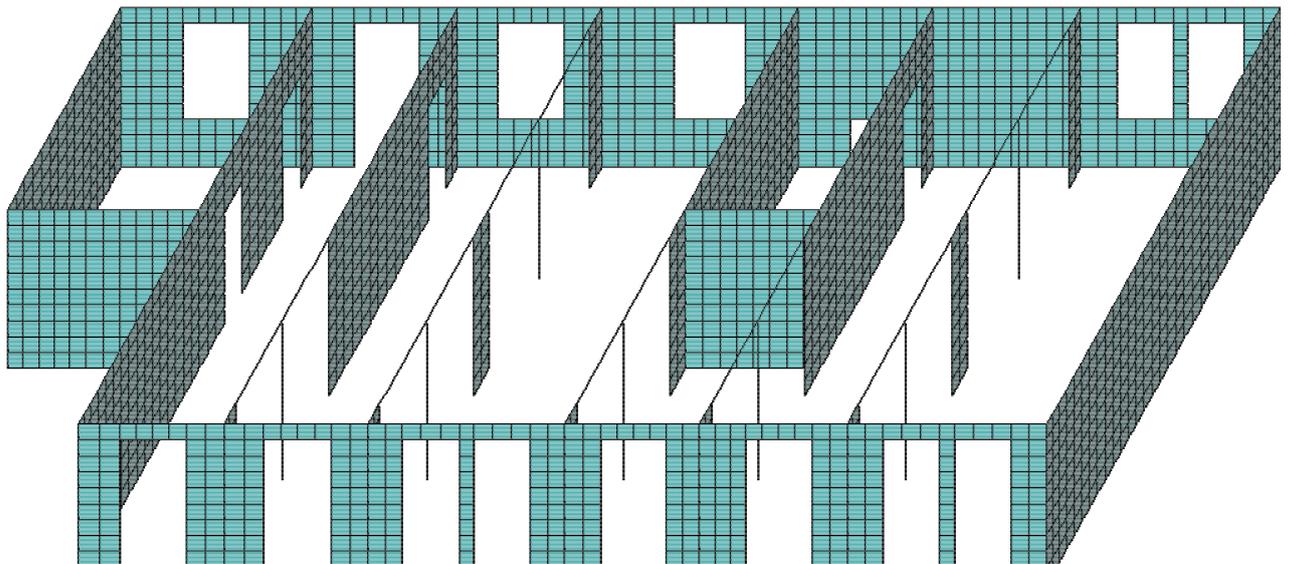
Розрахункова схема несучих стін нежитлових приміщень 1-го поверху після реконструкції.
